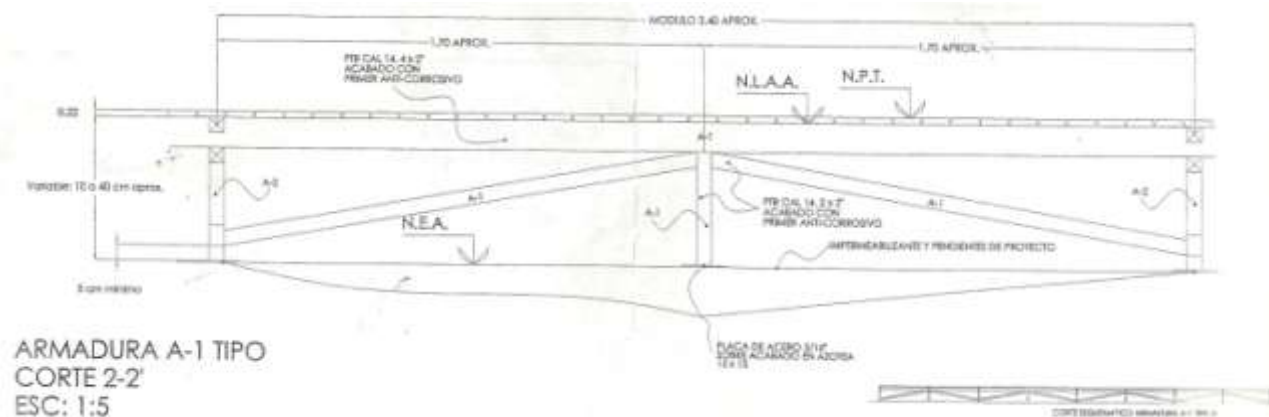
Vista Perfil de la Estructuración del piso Deck
